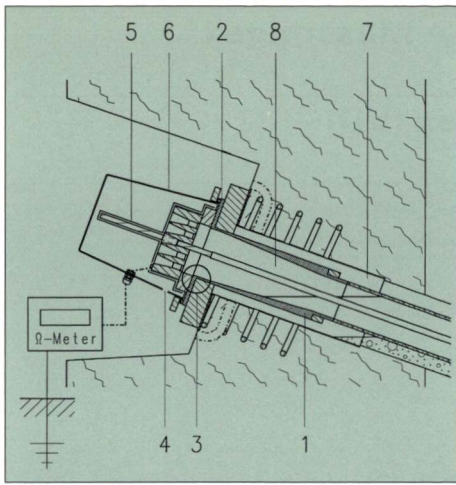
Zusatzanker mit vollständig elektrisch isolierter Ankerkopfkonstruktion (Typ «Werksschweissung») Fig. 3: Additional anchor with electrically insulated anchor head (shopwelded type)
